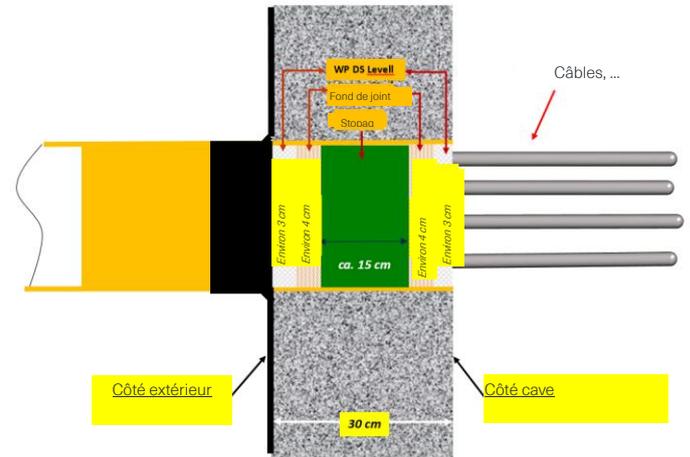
détail de l'étanchéité à l'eau de la traversée de tuyau - étanchéité dans le tuyau
